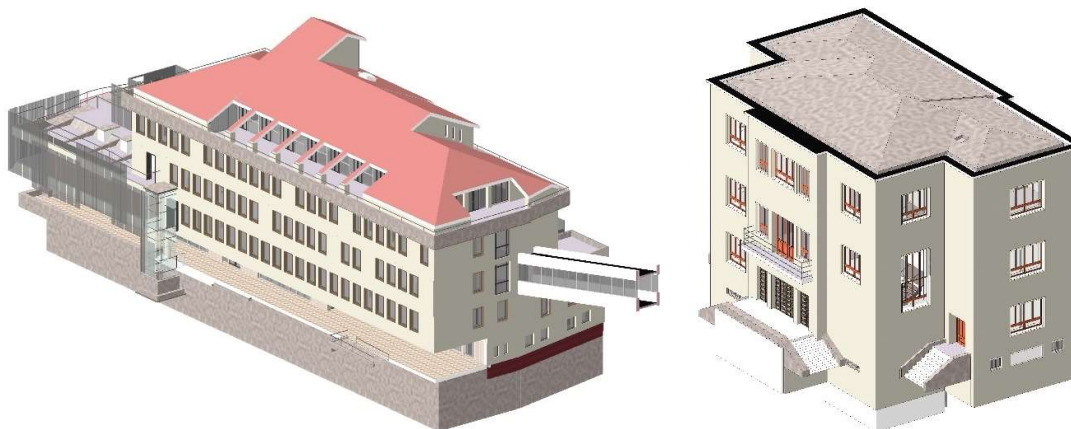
Vista fabbricati di progetto, MN e MV - Revit
